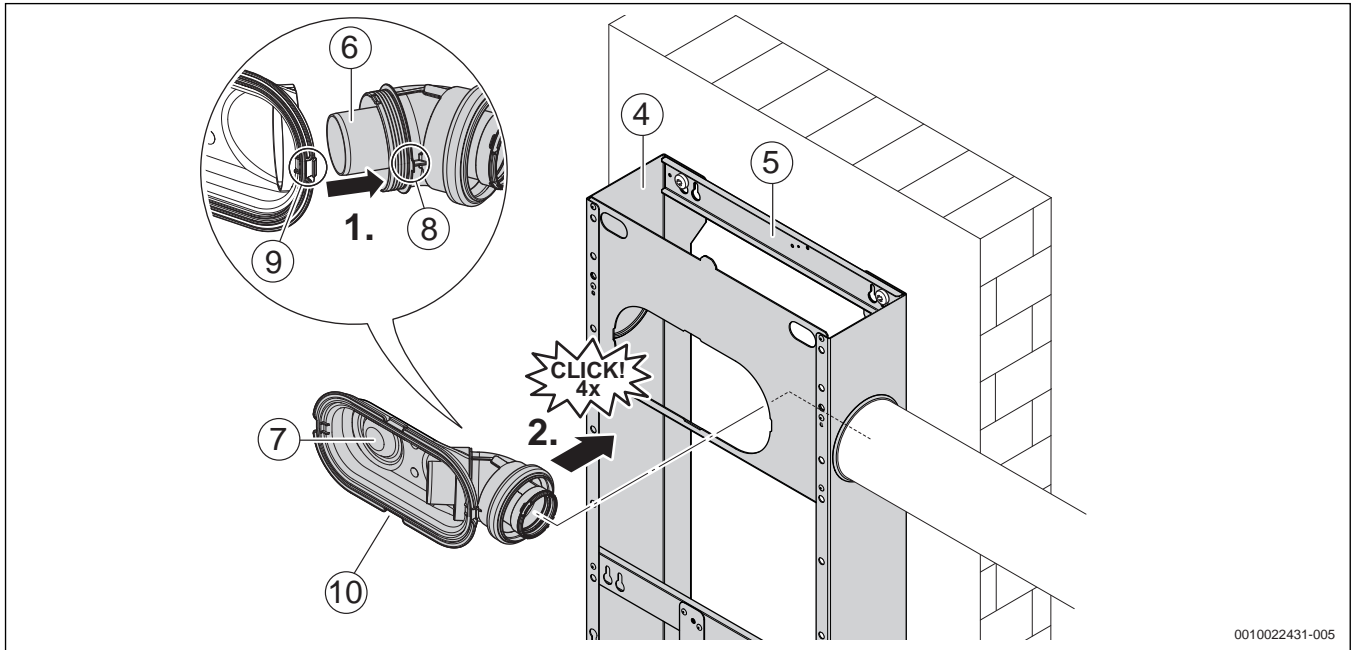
Montagerahmen aufhängen, Abgasanschluss seitlich (exemplarisch: Montage an Befestigungspunkten C)
